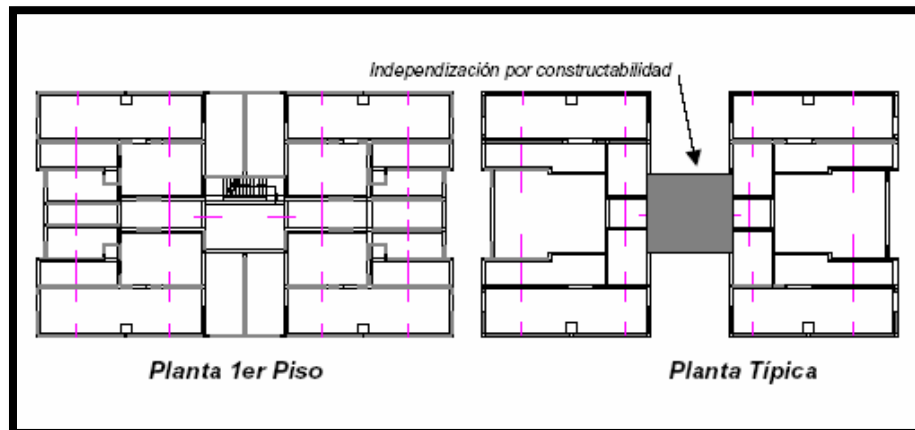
Plano de planta del edificio (Orihuela et al., 2003)
